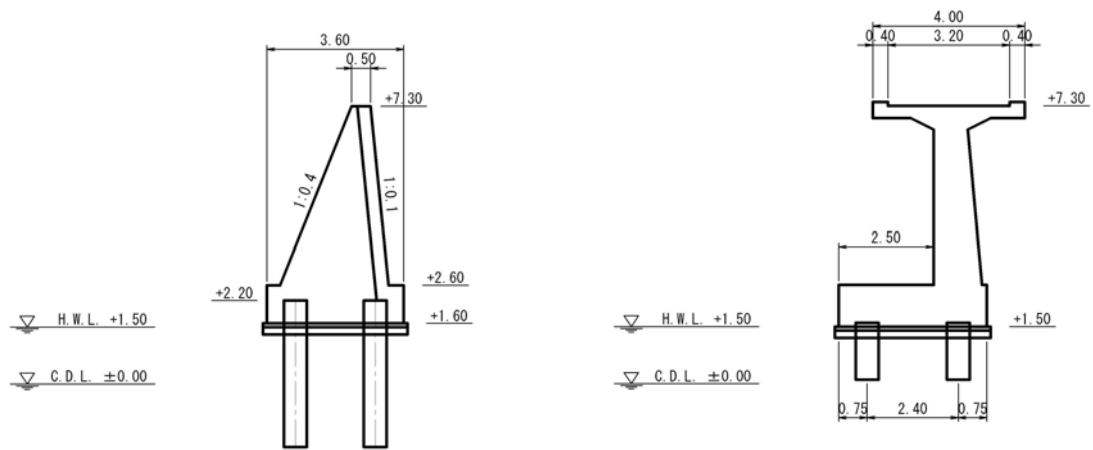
防潮堤断面図 (左図：胸壁、右図：テラス式)
